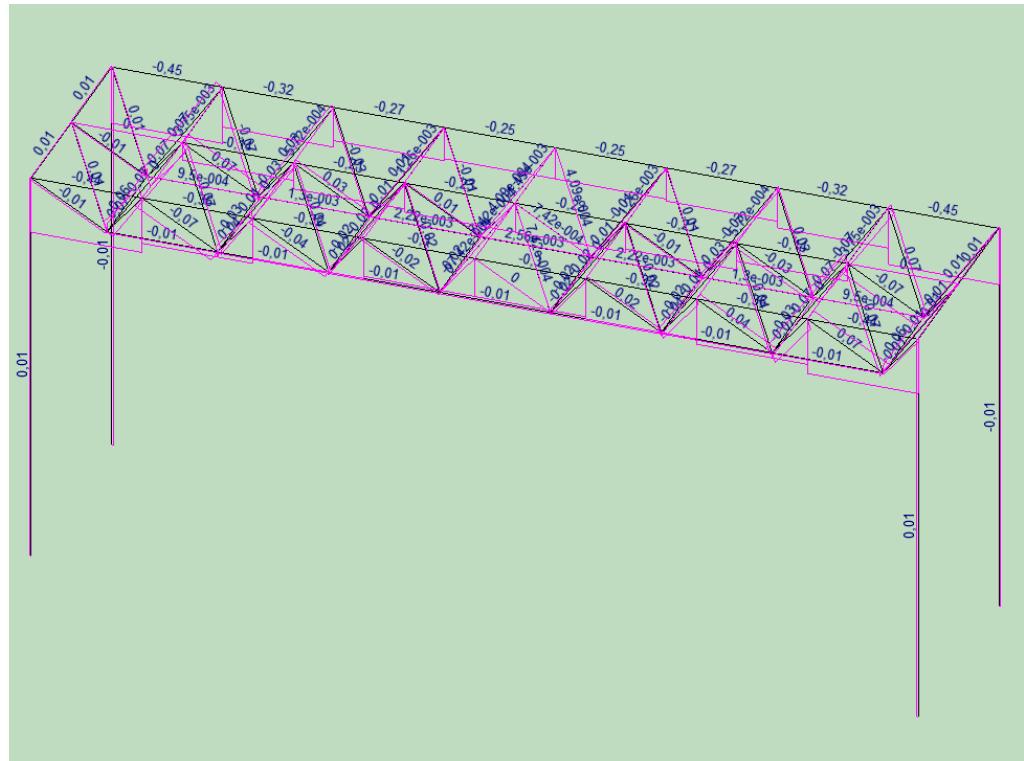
Усилия от ветровой нагрузки (1 вариант)
